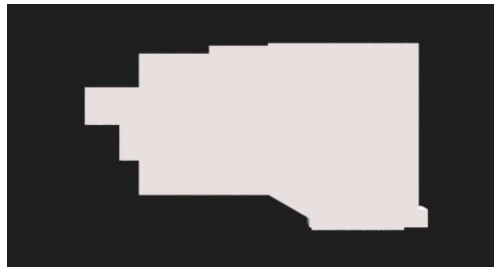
Planta en Forma de USB. Fuente: Elaboración propia.
